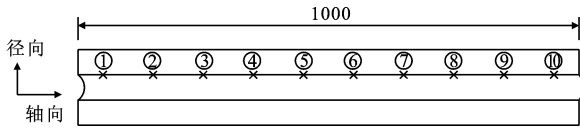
隧洞围岩温度监测断面平面布置图(单位:m)
